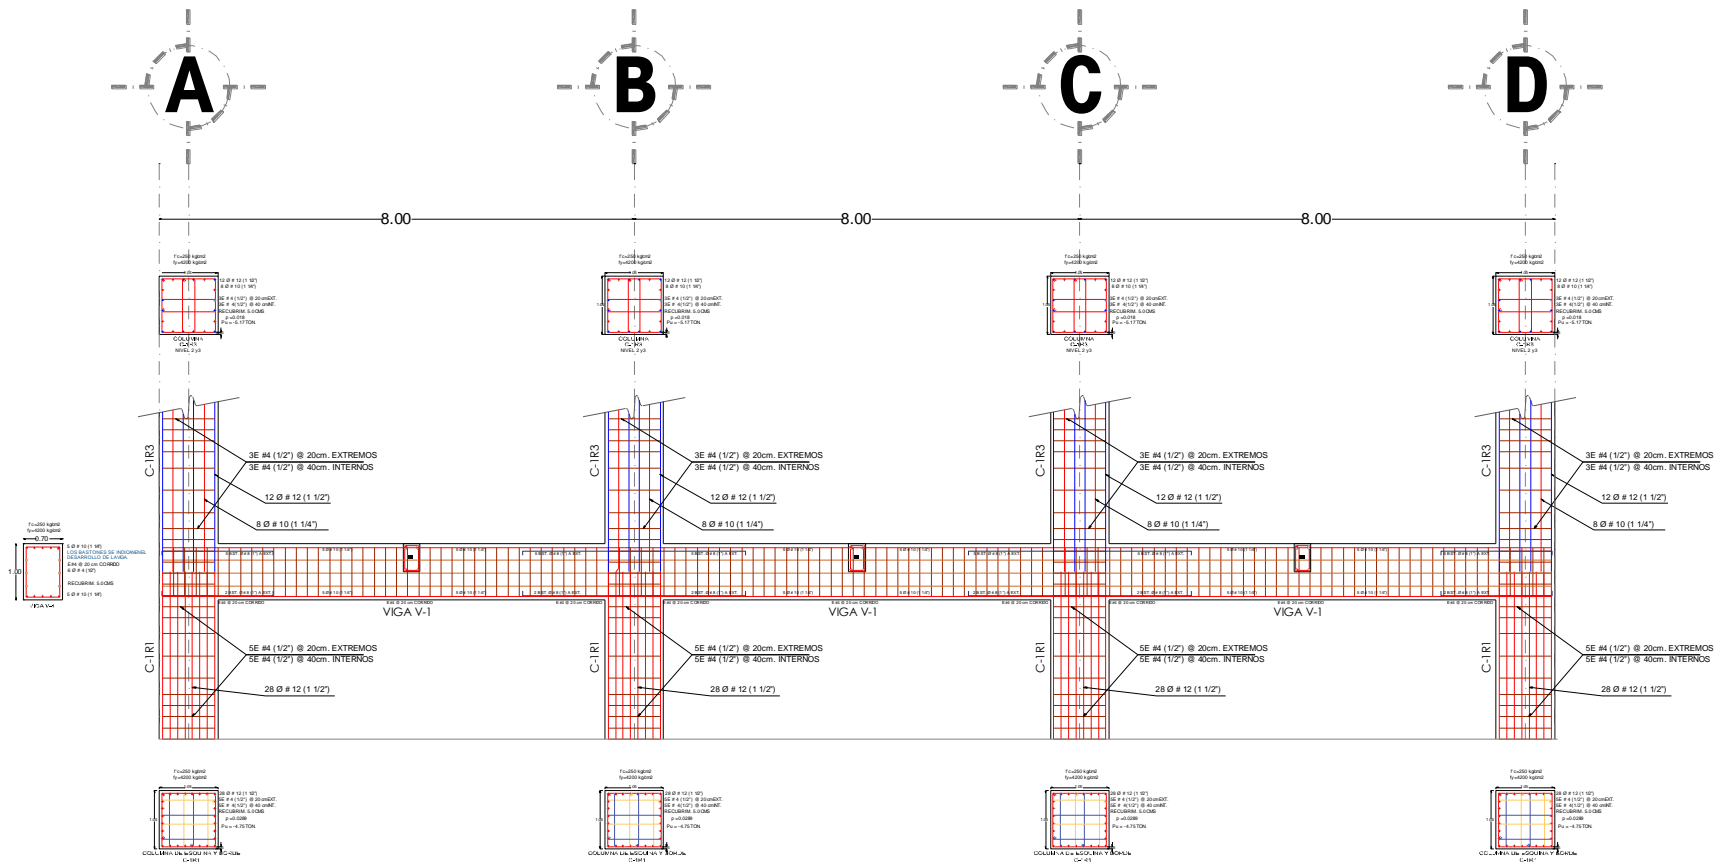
Alzado de armado de columnas y vigas de edificio de 9 niveles con base a la hipótesis de las NTCC-04.
